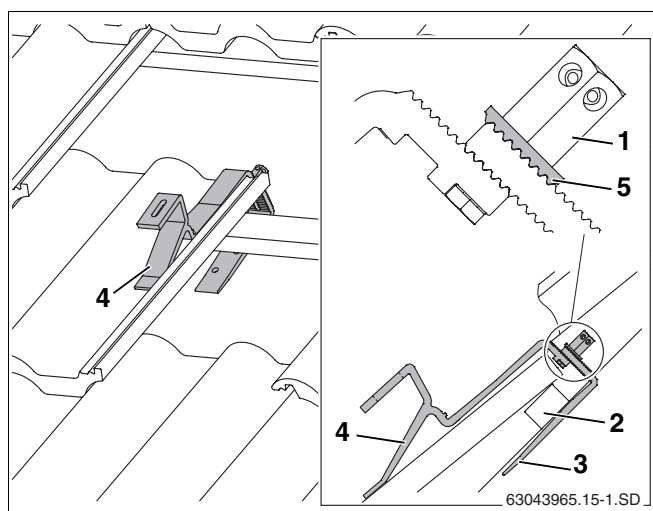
Gancho de tejado enganchado (para facilitar la vista se han eliminado de la figura algunas tejas)
